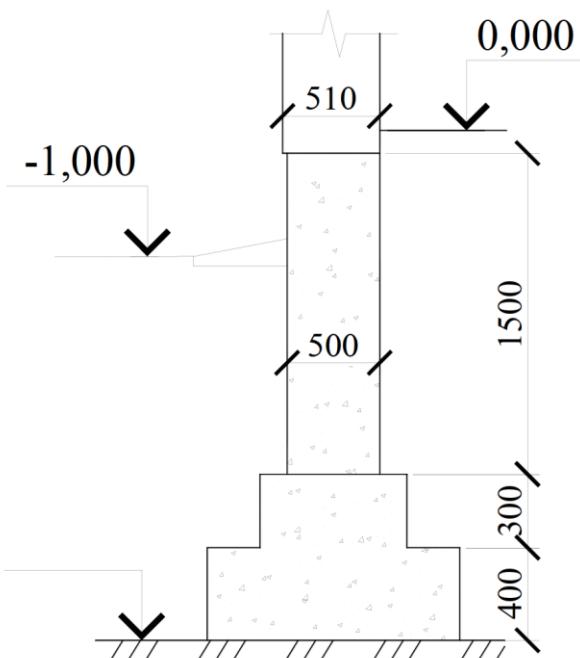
Стрічковий бутобетонний фундамент
